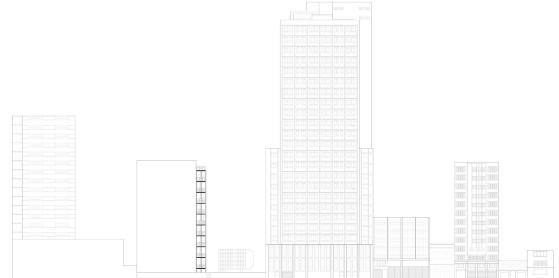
Elevación cuadra, Av. Prestes Maia. Fuente: Elaboración propia.
